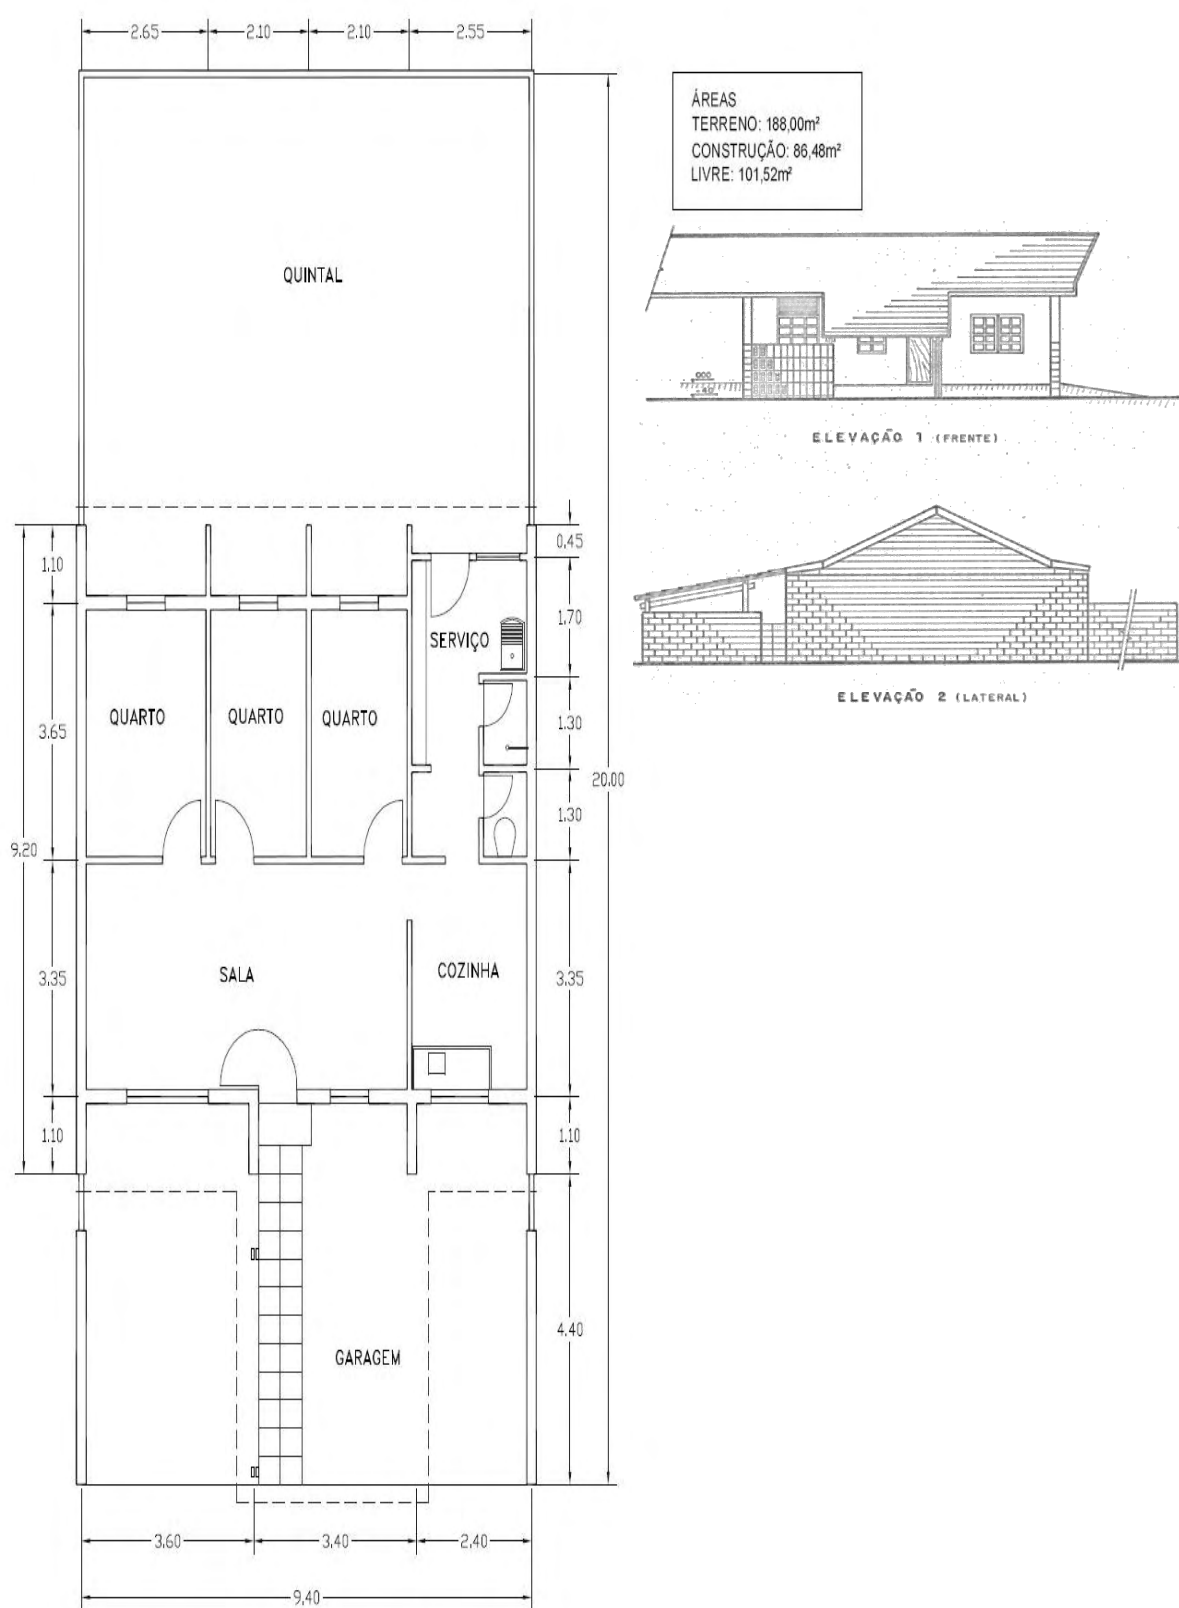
Figura D – Planta e elevações da casa tipo 4 (MANGE; KATO, 1963)
